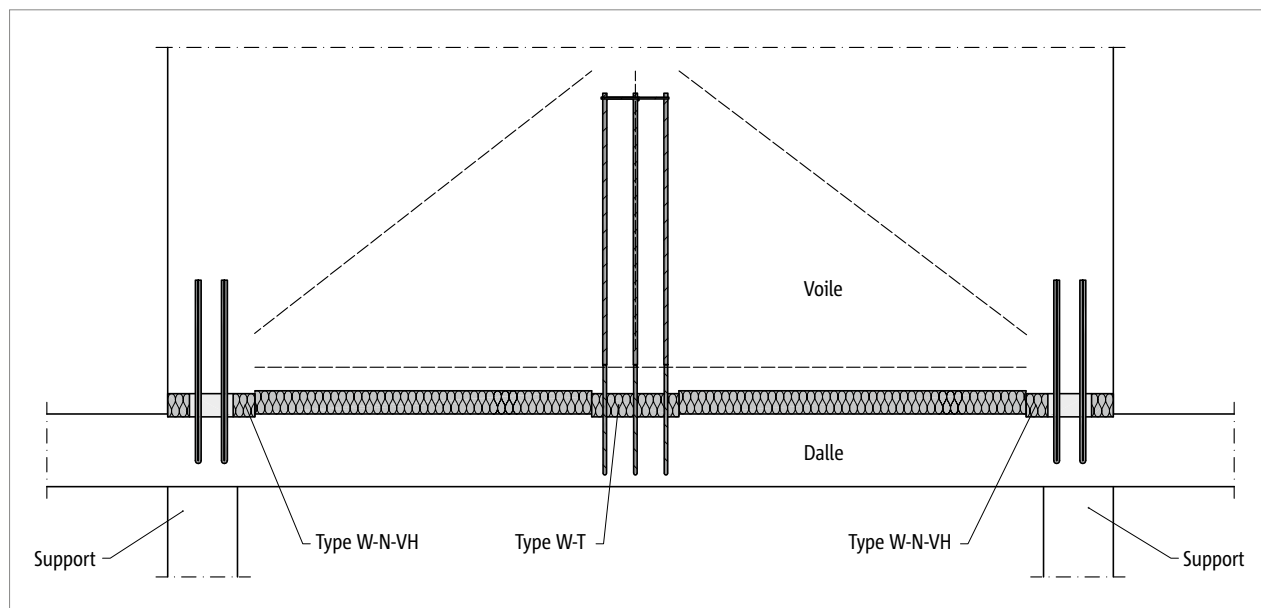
Schöck Sconnex® type W : variantes de produit combinées pour le raccordement d'un support mural avec une suspension à la dalle
